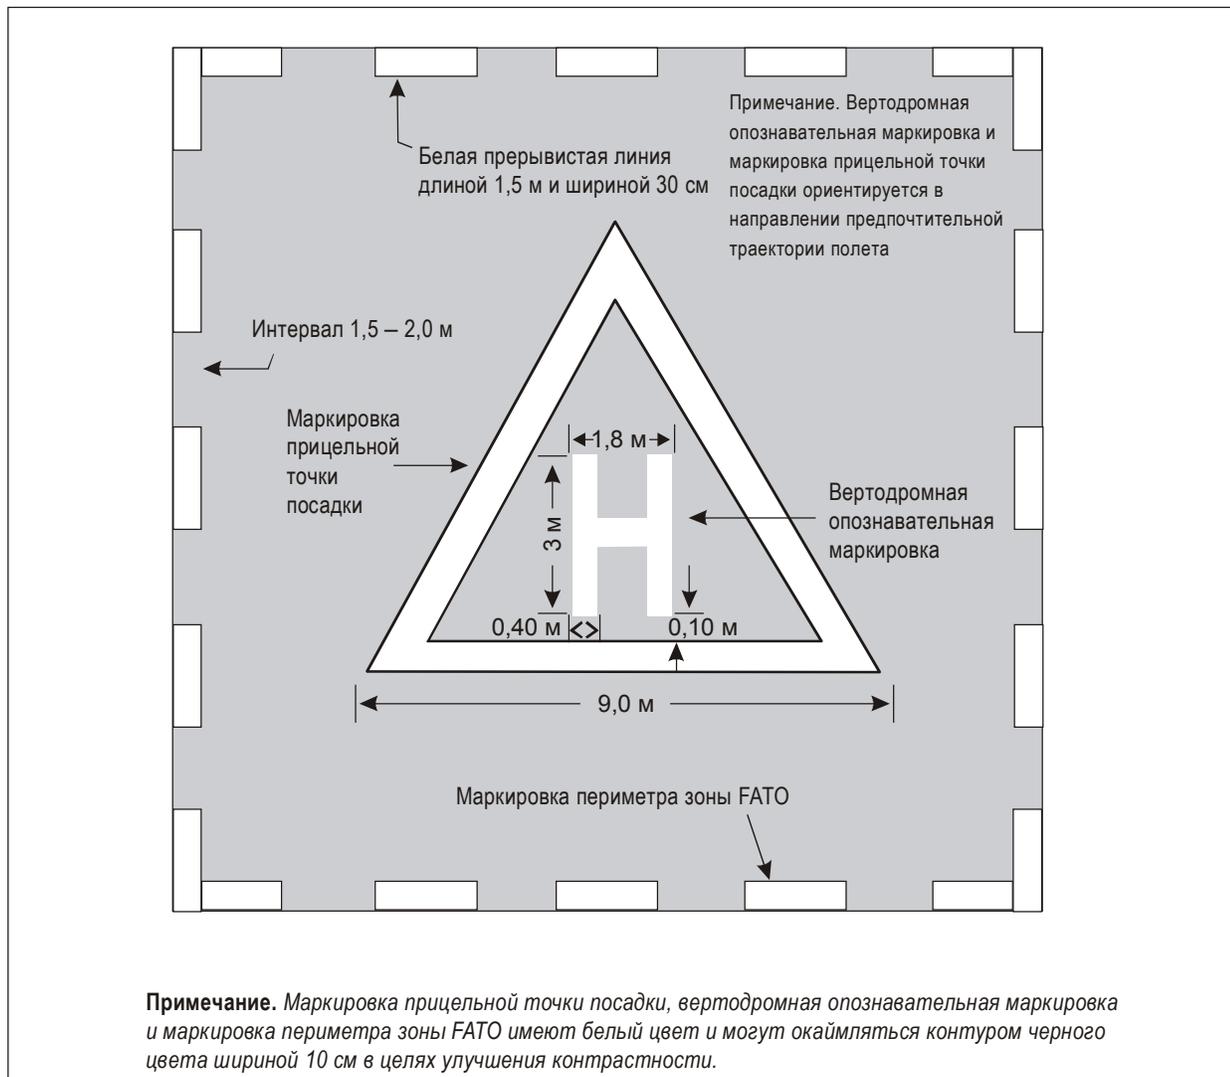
Совместные вертодромная опознавательная маркировка, маркировка прицельной точки посадки и маркировка периметра зоны FATO
